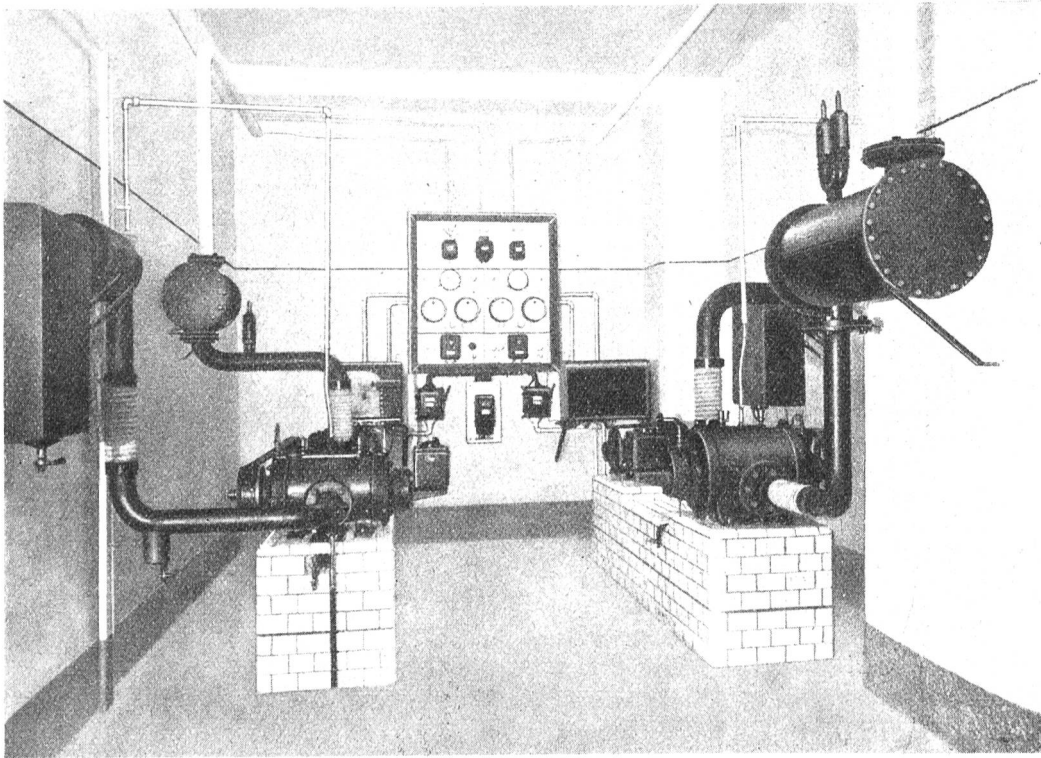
Gebläse mit Motorantrieb im Postamt Basel 2. — Salle des machines pour la soufflerie, à Bâle 2.
